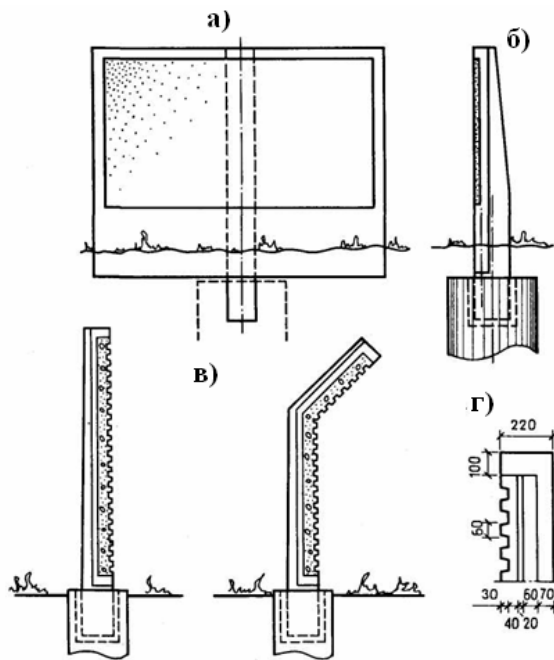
Екран із залізобетону: а) фасад; б), в), г) розрізи
